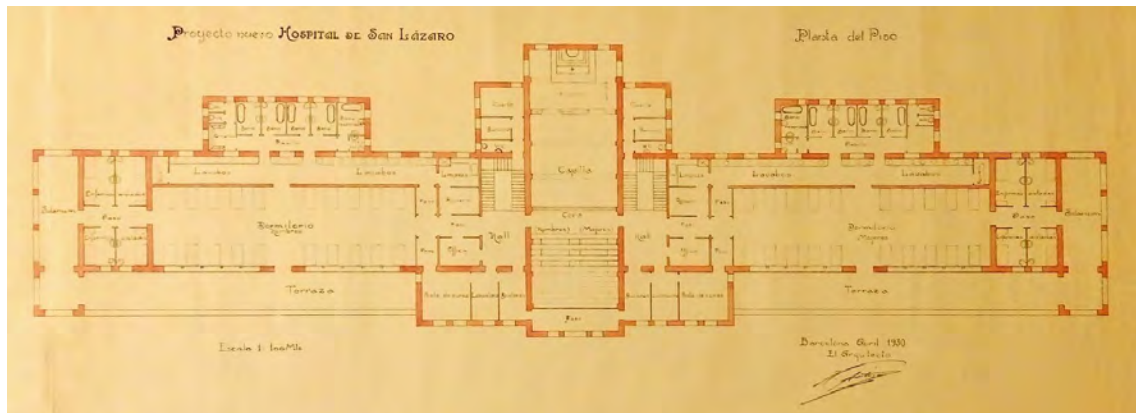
Plano de la planta primera del Hospital de Sant Llàtzer⁸
